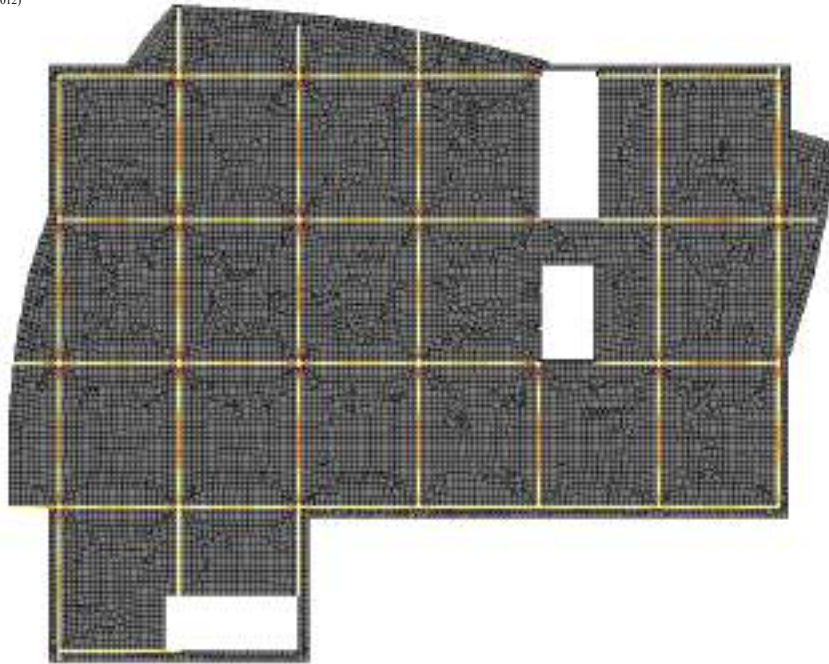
Суммарная арматура балок плиты перекрытия типового этажа.
